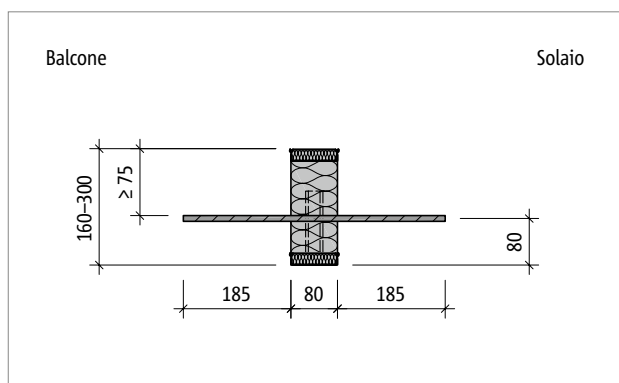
Schöck Isokorb® T tipo HP-NN1: sezione dell'elemento
